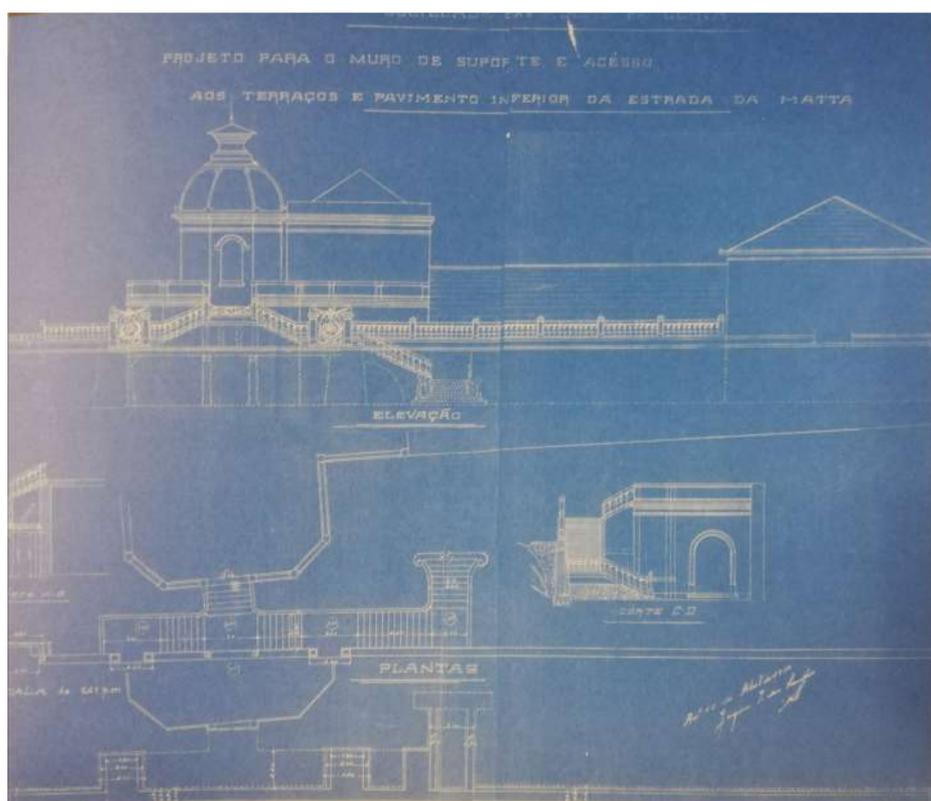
| Planta da escadaria e muro de suporte de terras junto da Buvette de Jaime Inácio dos Santos. (1914)
